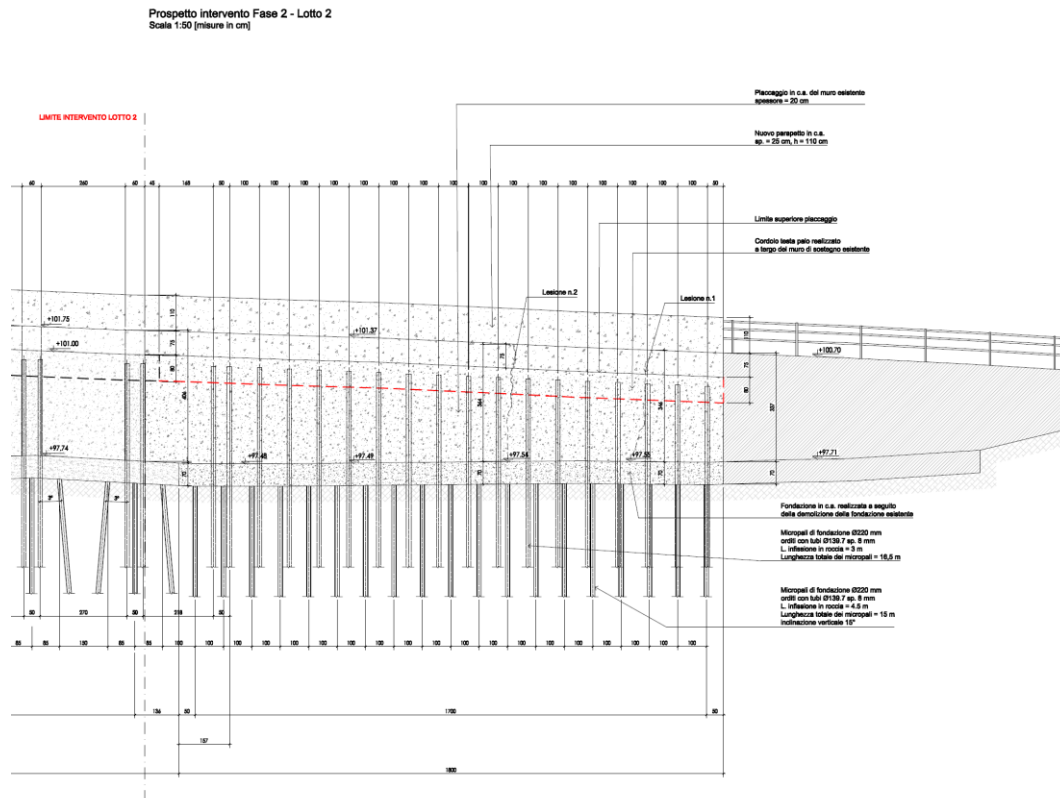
Prospetto intervento Lotto 2 – Fase 2
